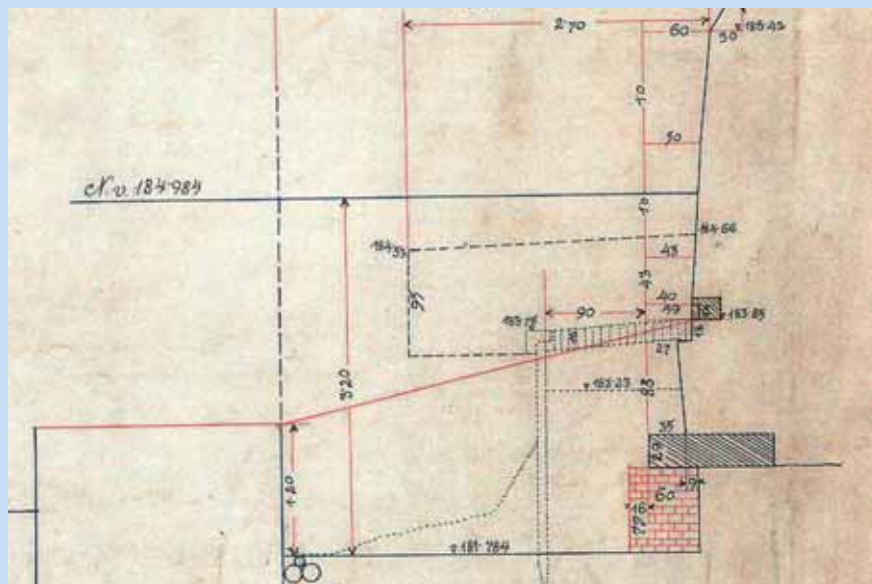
Detail příčného řezu podzákladí pilíře č. 9 se zakreslenou špuntovnicí, archiv TSK
